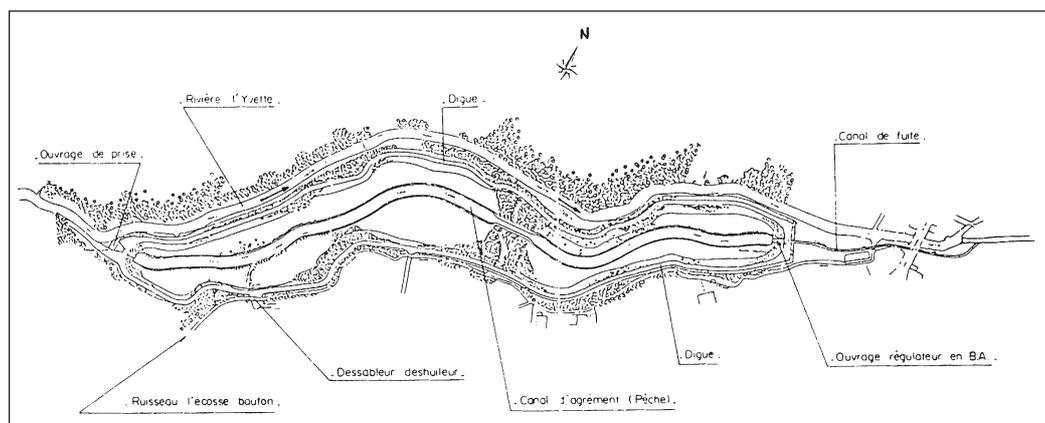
Bassin de retenue de Chevreuse plan général, source : SIAHVY
